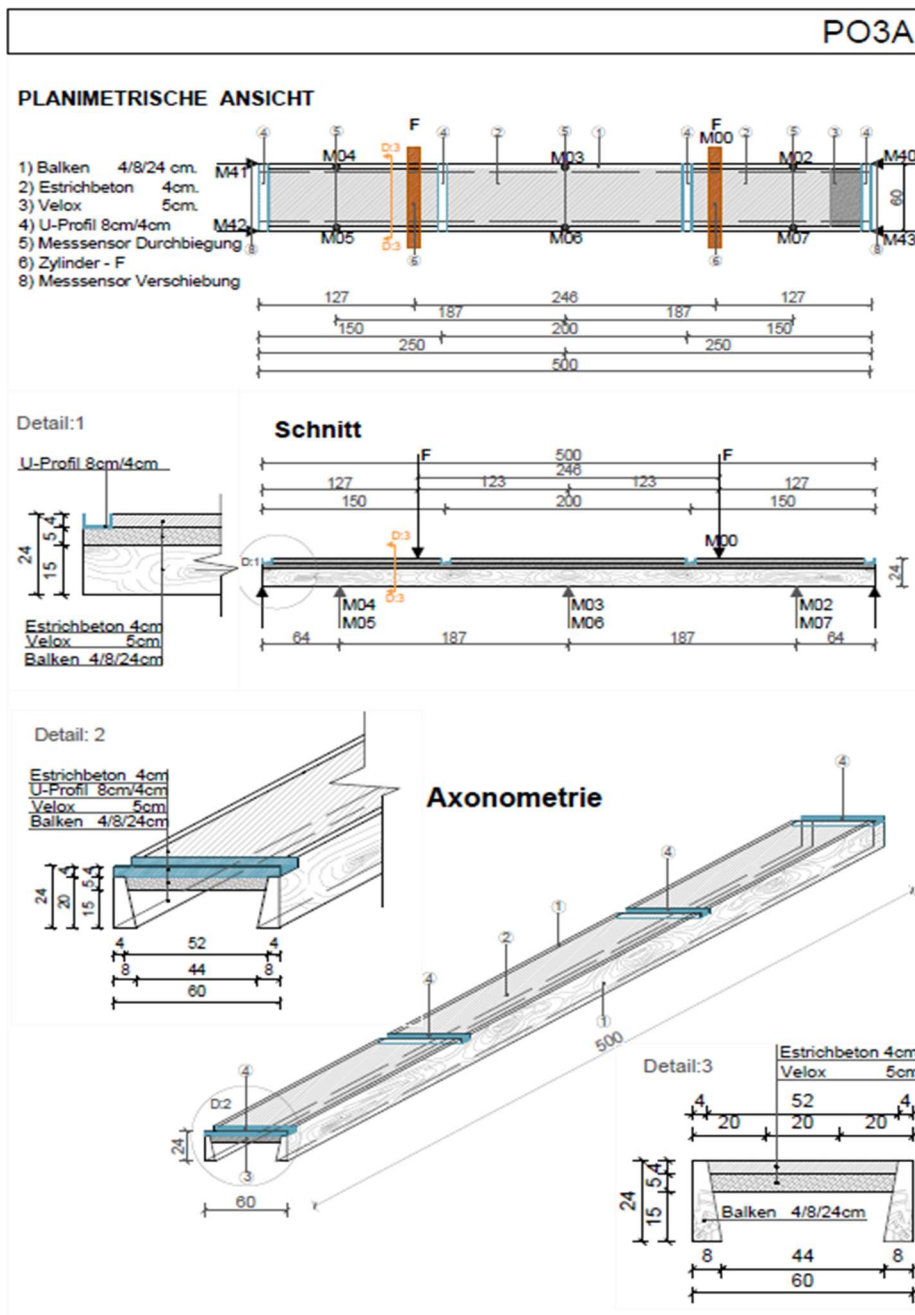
Planimetrische und axonometrische Darstellung des Bauteils P03A einschließlich der Bauteil-Schnitte.
